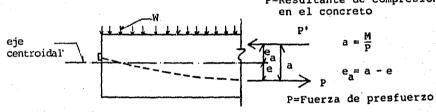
Momento interno resistente en vigas de concreto presforzado.
